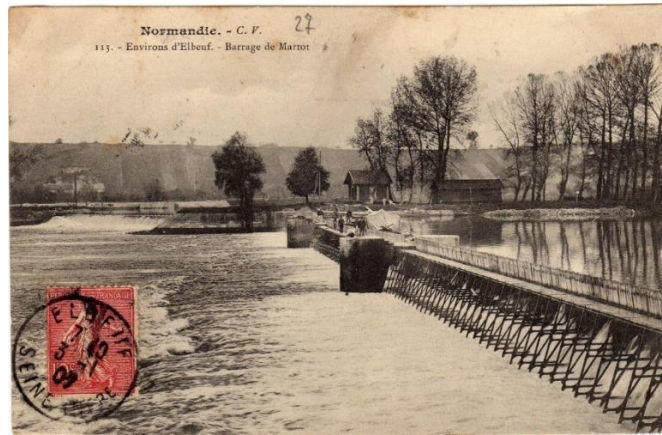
Photographie du barrage de Martot au début du vingtième siècle. Au premier plan, la première partie du barrage entre la rive gauche et l'île au Moine (169.6 m). Au second plan, le déversoir de Blanchetterre (135.0 m).
